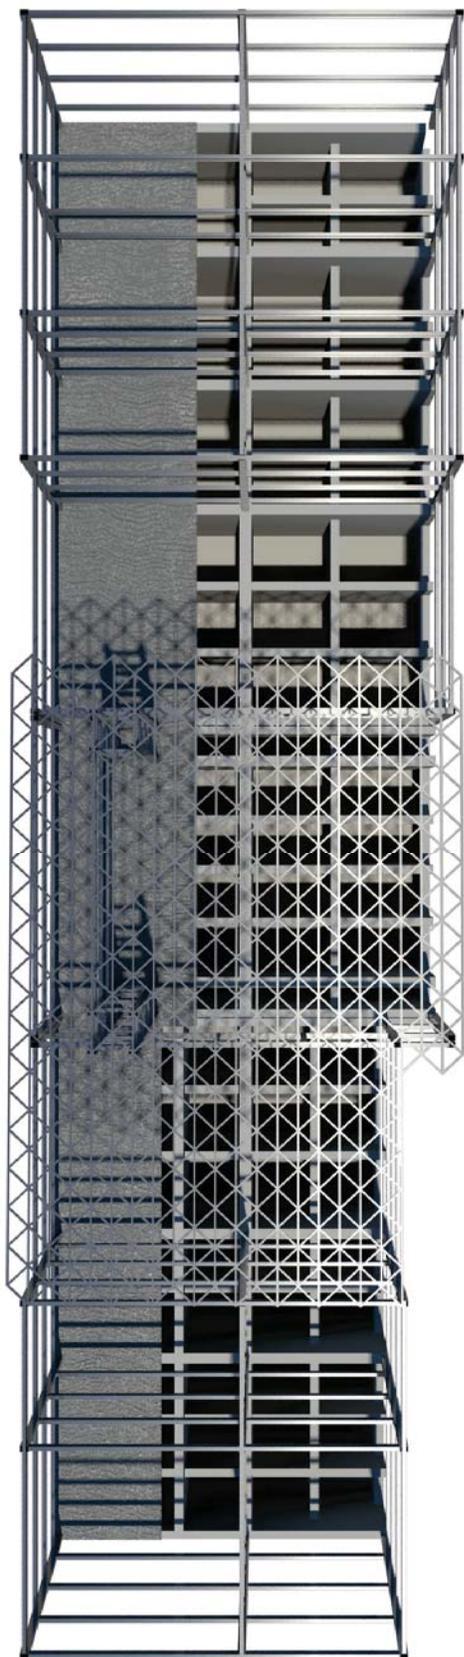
Modelo tridimensional de la estructura. Vista planta.
